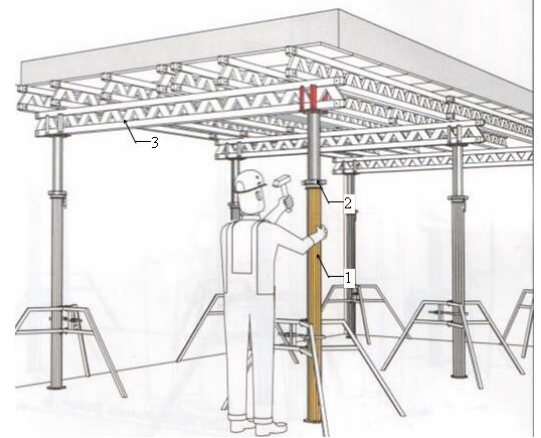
Опускання настилу опалубки: 1 – основна стійка; 2 – регулювальна гайка; 3 – поздовжня балка
